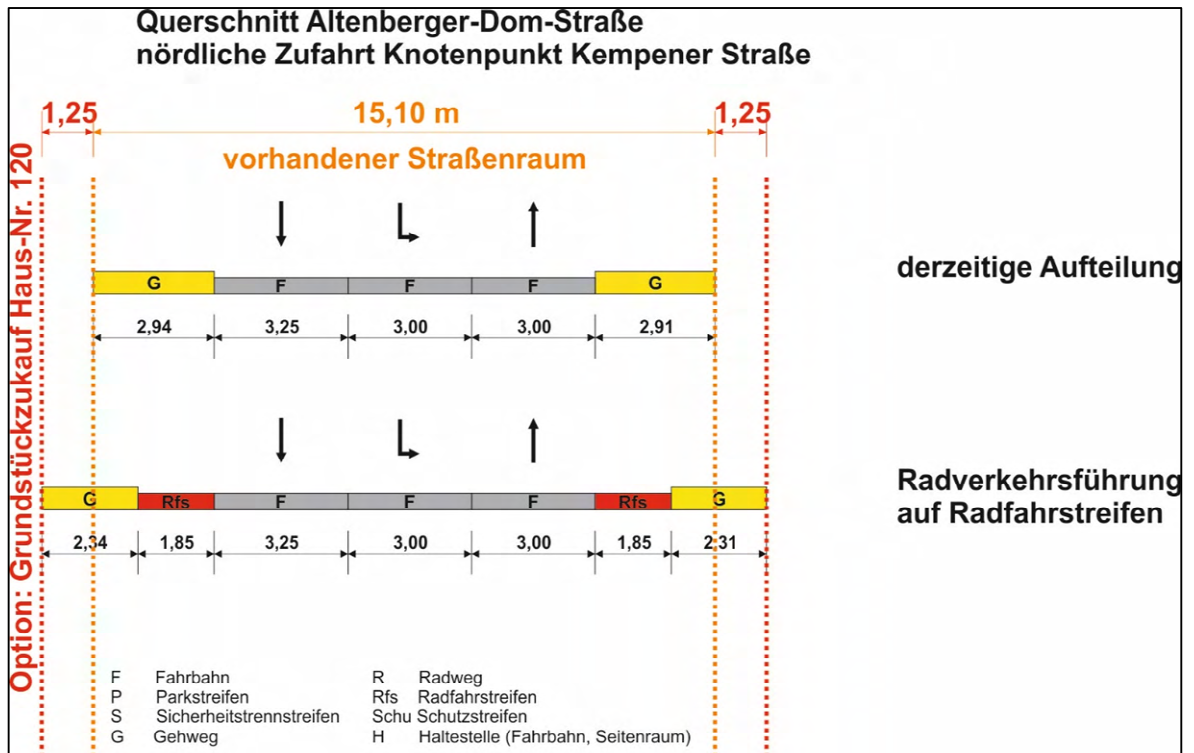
Querschnitt – nördliche Zufahrt Knotenpunkt Kempener Straße
